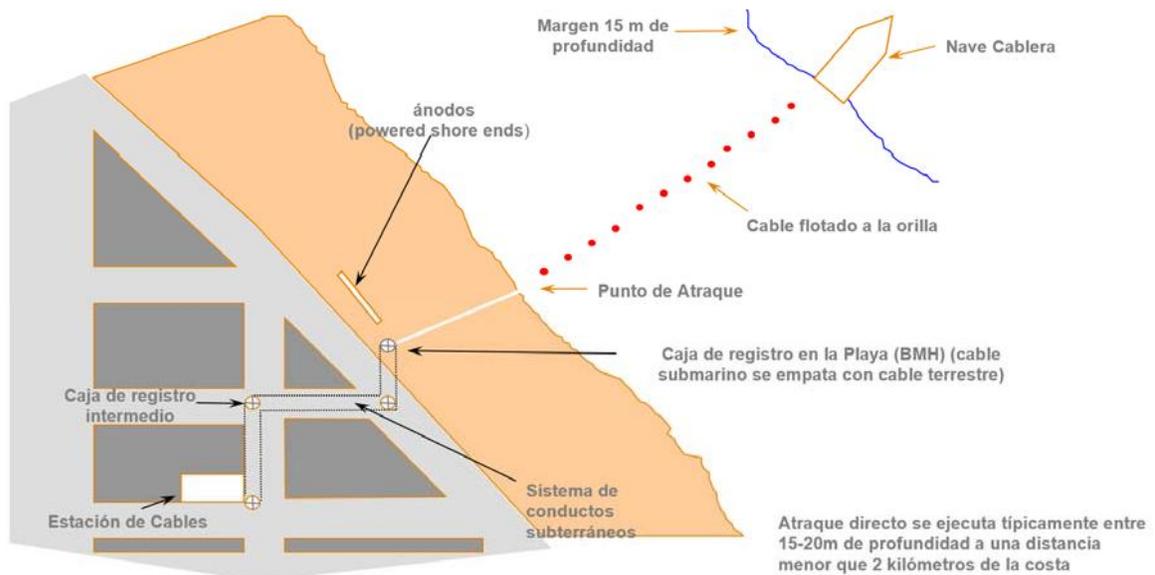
Instalación Marina Atraque Directo de Buque Cablero
